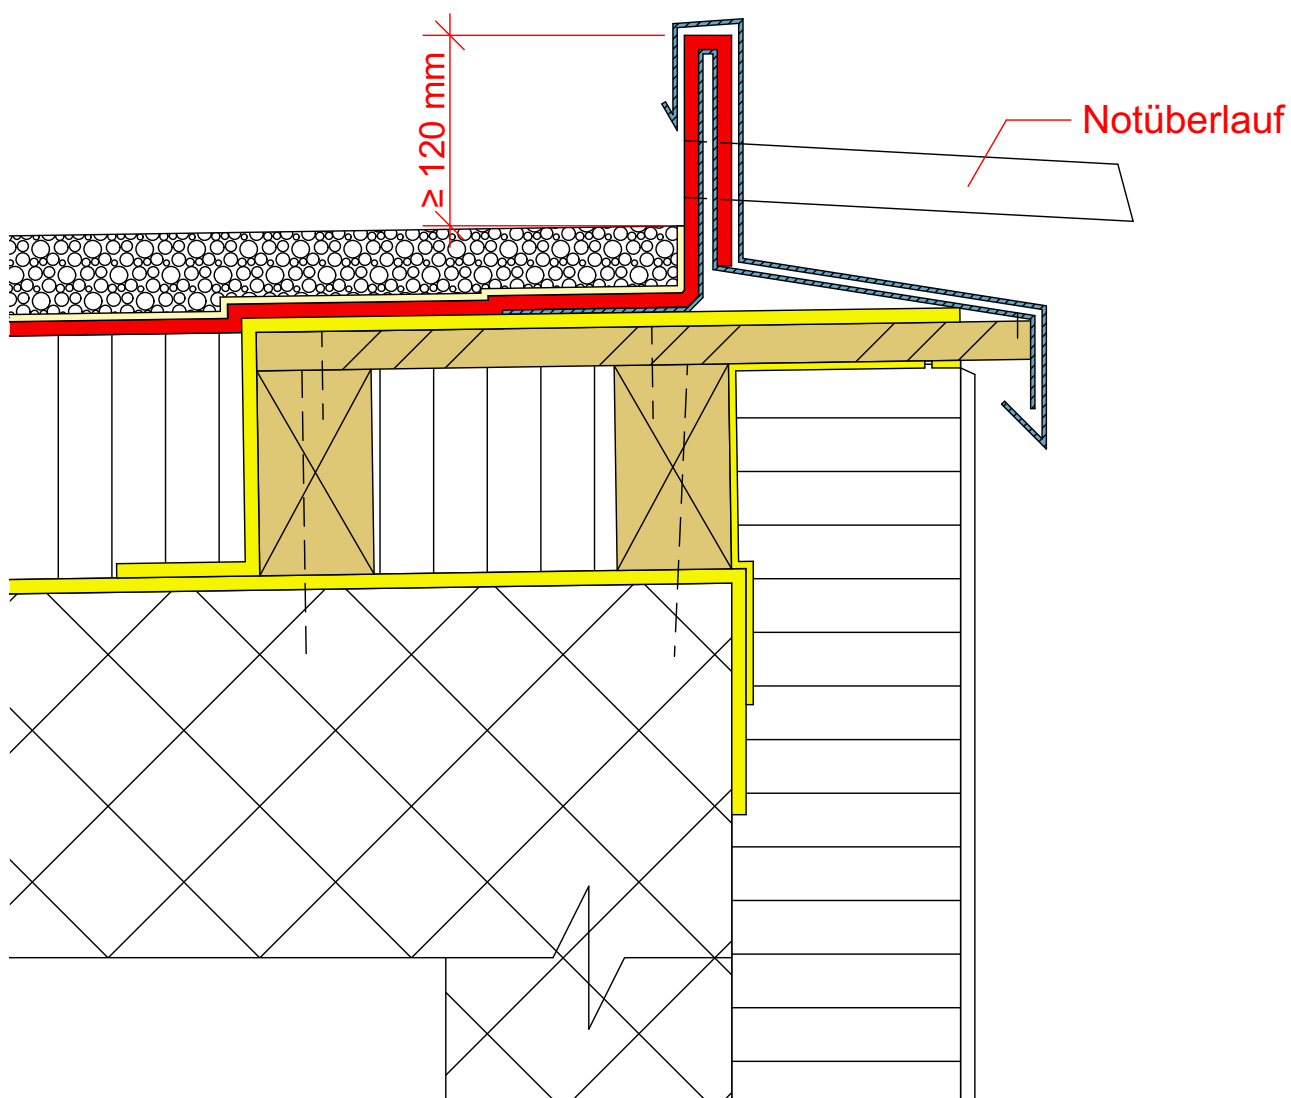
Nicht überlaufsichere Dachrandkonstruktionen
